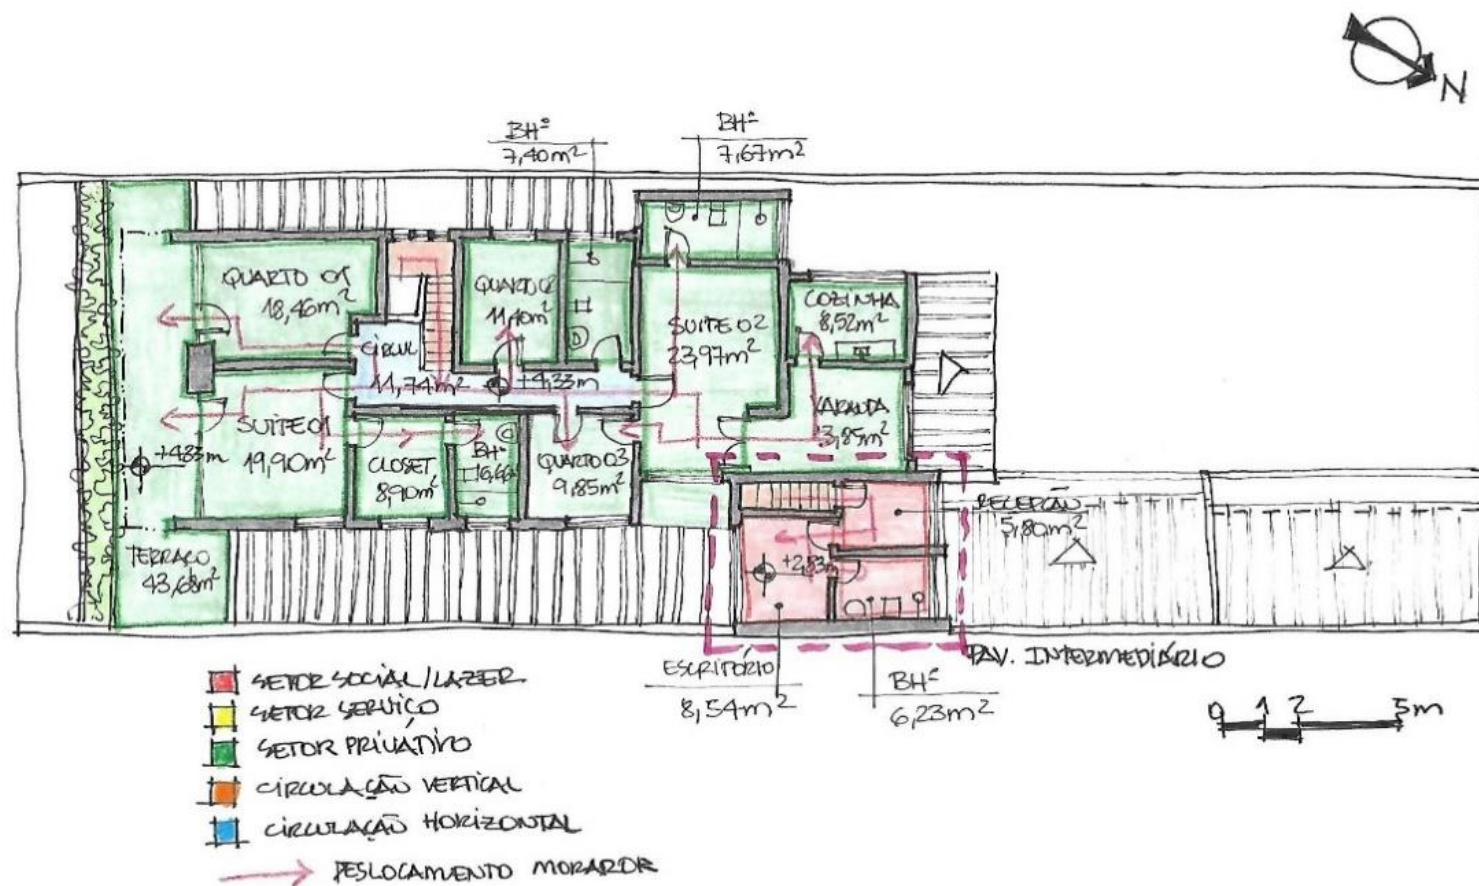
Planta baixa do pavimento superior e intermediário da Residência Nº 1.831 (Década de 1960). Fonte: autora, 2019.
